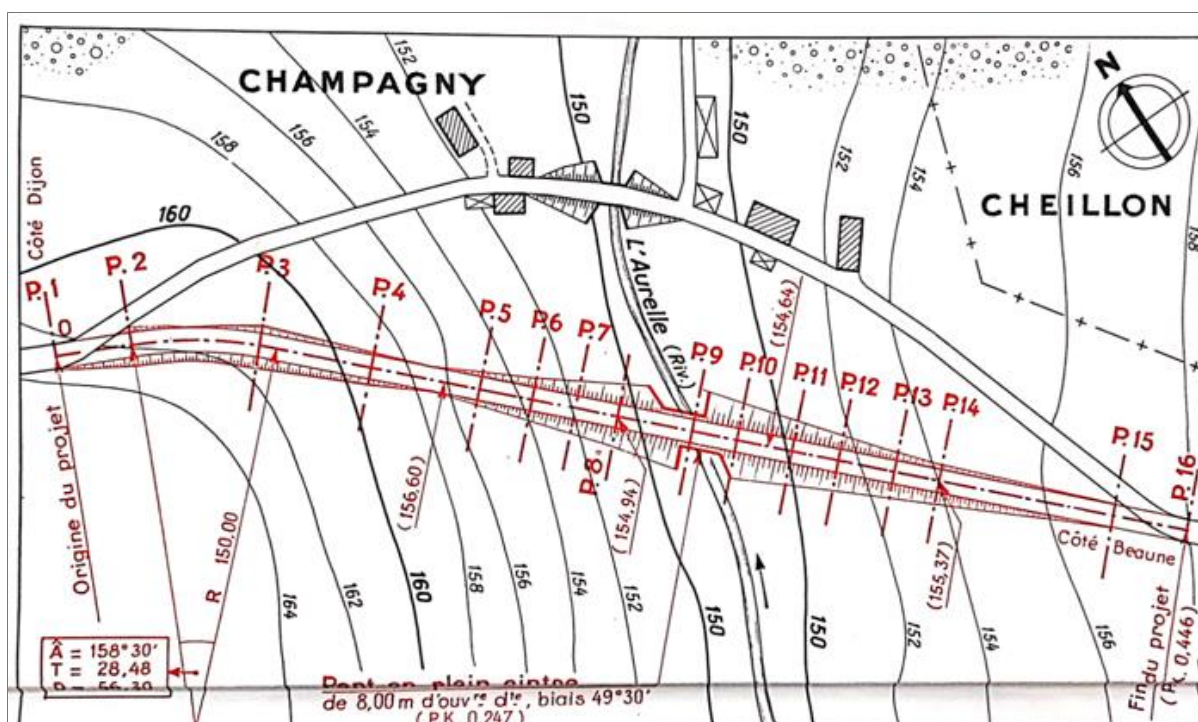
Aspect général d'un tracé en plan d'un projet routier[7]
